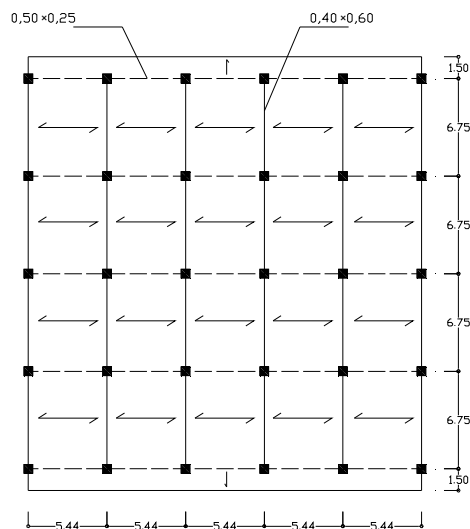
Planta estrutural tipo do edifício de betão armado.
